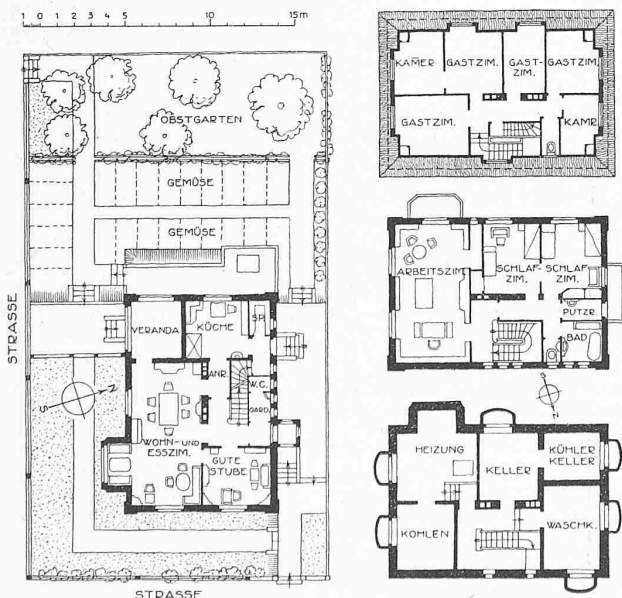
bis 4. Lageplan und Grundrisse 1:400 des Hauses K. Muthesius.
